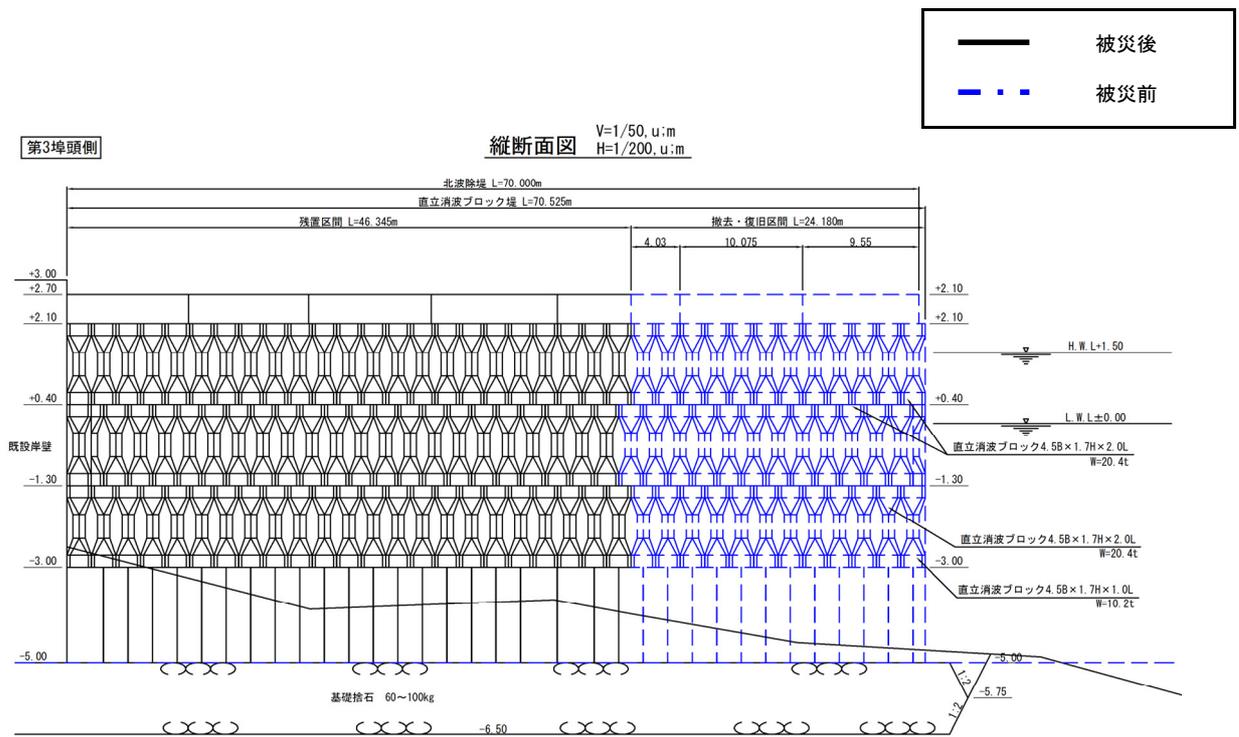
122 No.5 大洗港区_北波除堤の断面図 (被災後)
